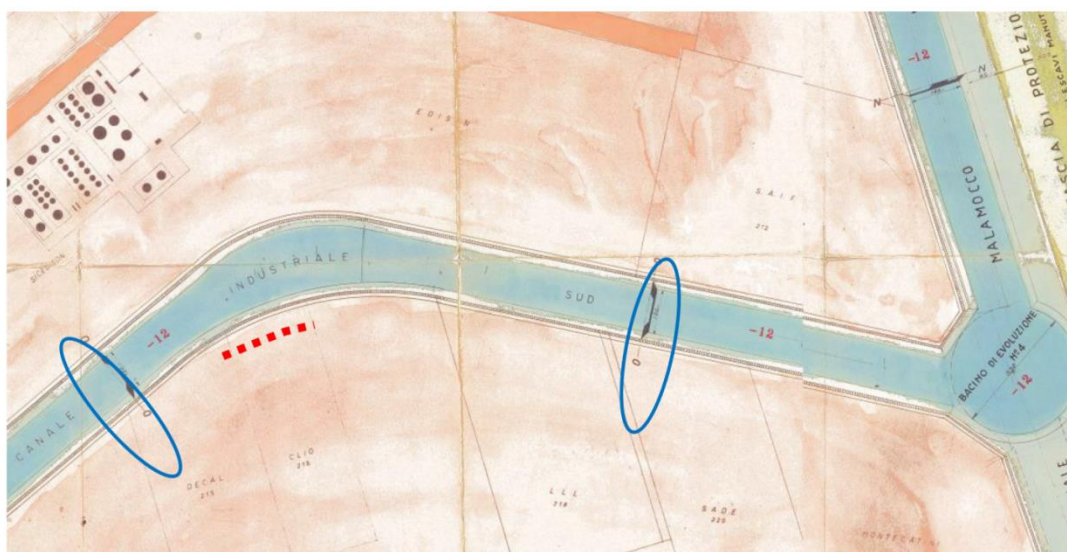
Planimetria PRP con evidenziate le sezioni 0-0 del canale industriale Sud (blu) e indicazione della banchina oggetto di intervento (in rosso)
